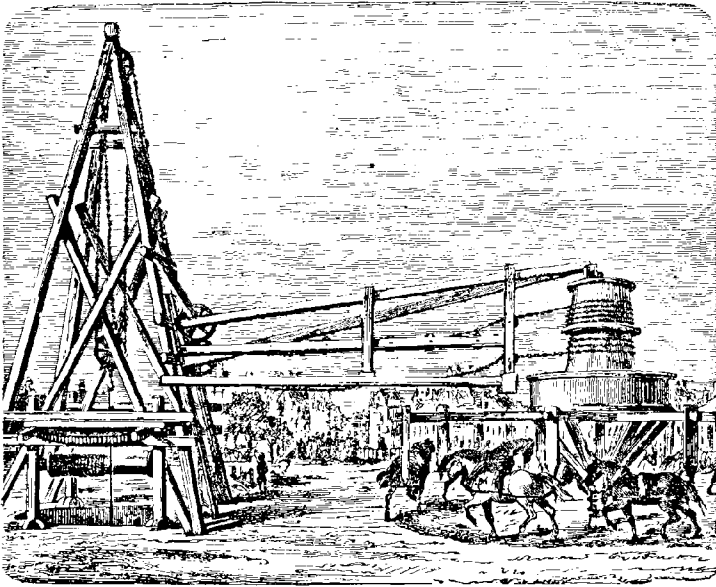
Creusement du puits de Grenelle avec un manège de chevaux.
